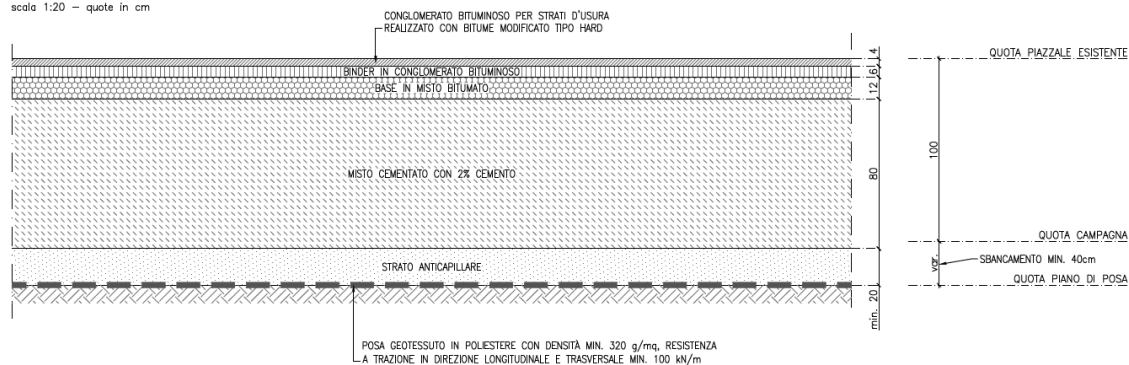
Estratto della tavola Sezioni Tipologiche: pacchetto di fondazione per il nuovo piazzale
